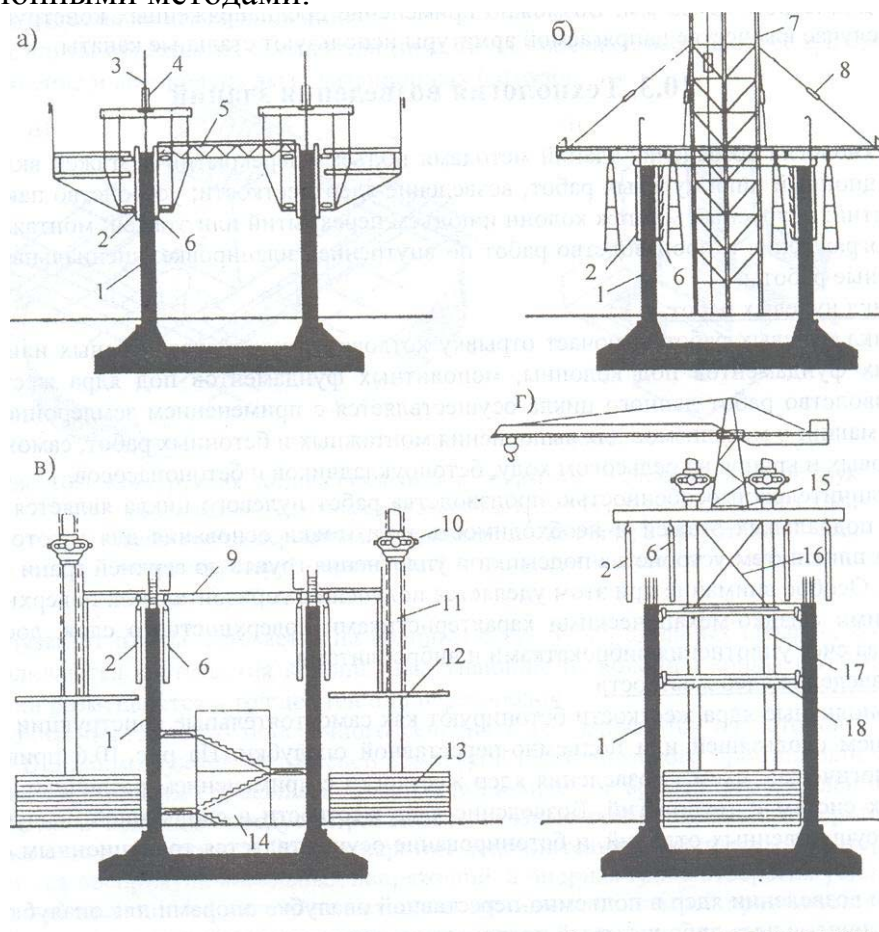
Способы возведения монолитных железобетонных стволов ядер жесткости:
